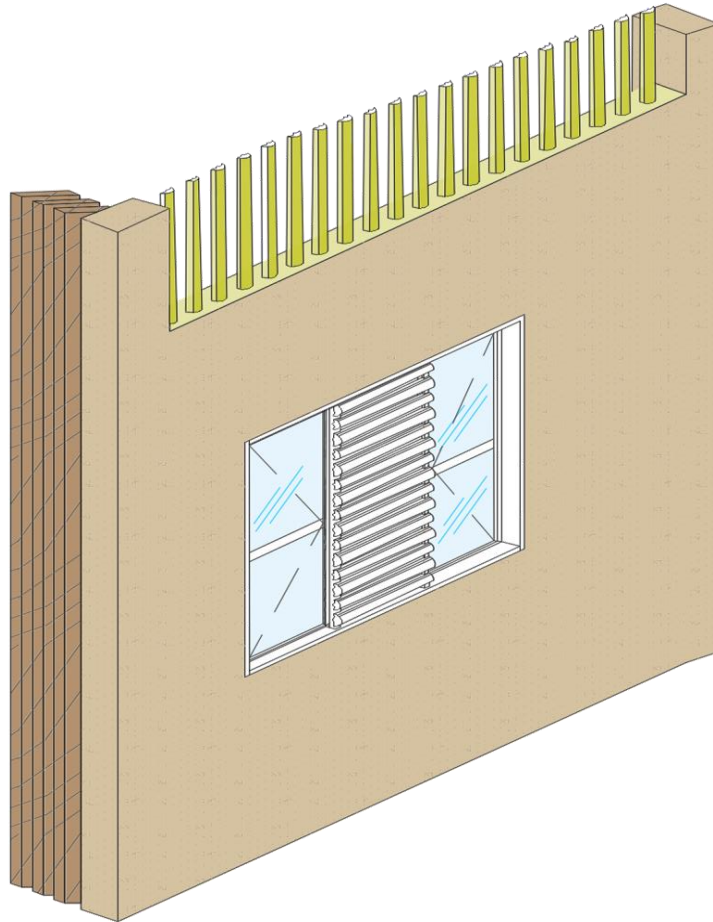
Despiece constructivo muro en tierra para espacio expuesto.
